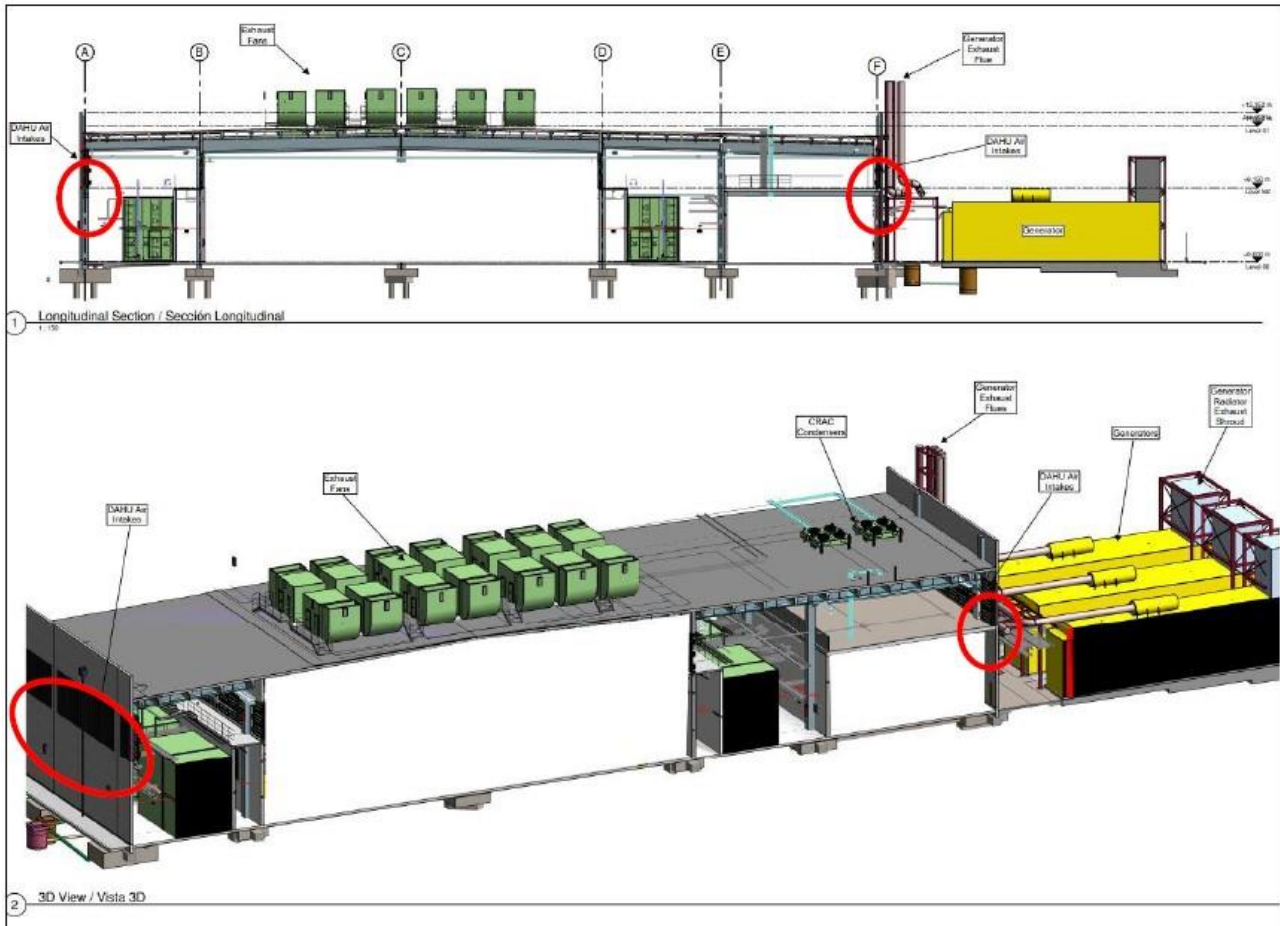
Sezione e prospetto esplicativi della posizione di macchinari interni e aperture laterali
